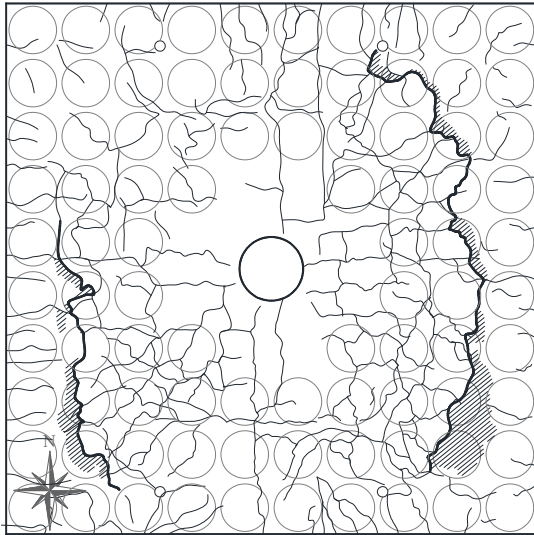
Mapa de fissuração da laje BD28-P3
